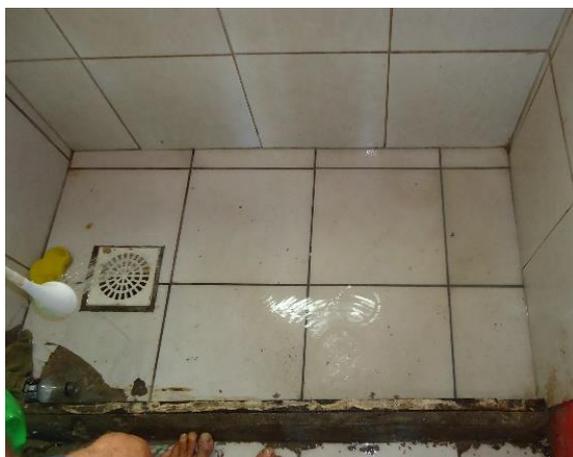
Piso fissurado no loteamento São Guilherme
